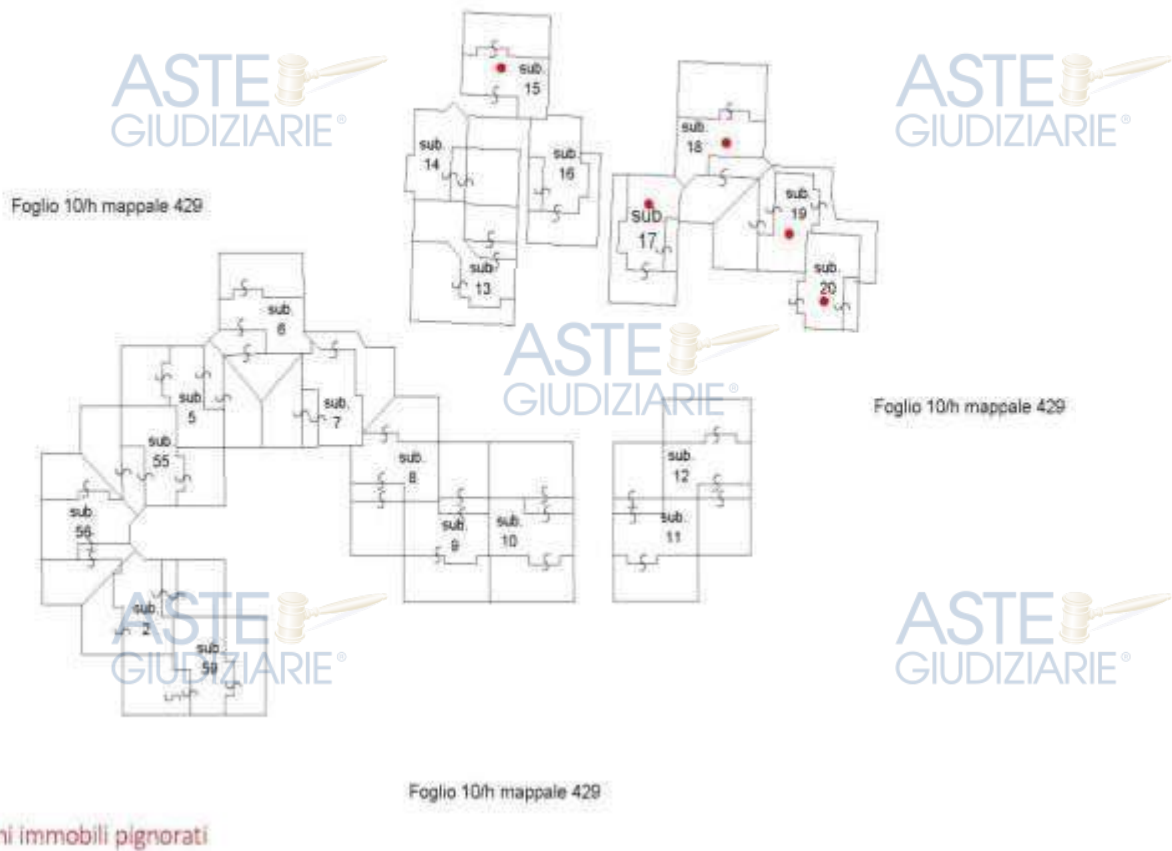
Ubicazione planimetrica parziale dei beni immobili pignorati GRUPPO B (S14)
